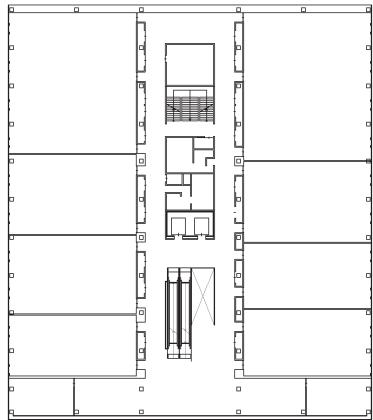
(1) 講義棟平面図（地下1階～地上2階）(1/2)
